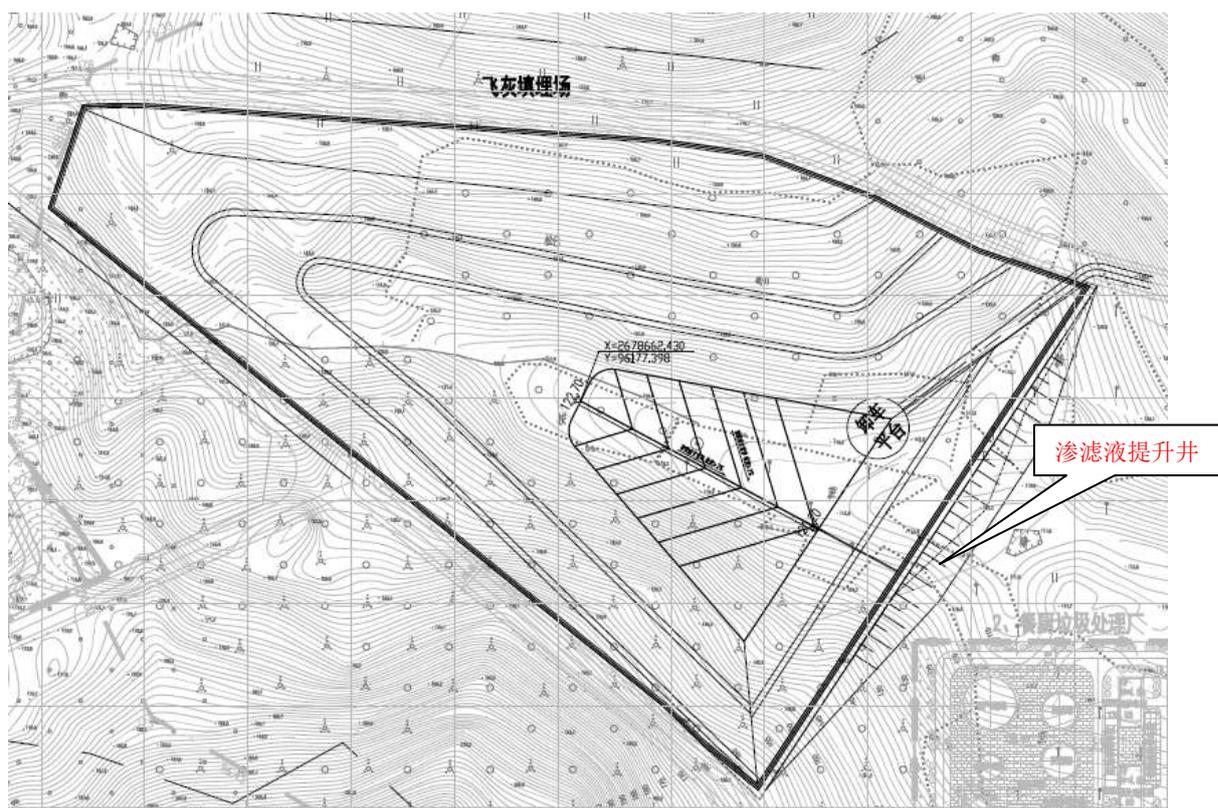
飞灰填埋区渗滤液导排系统平面布置图
